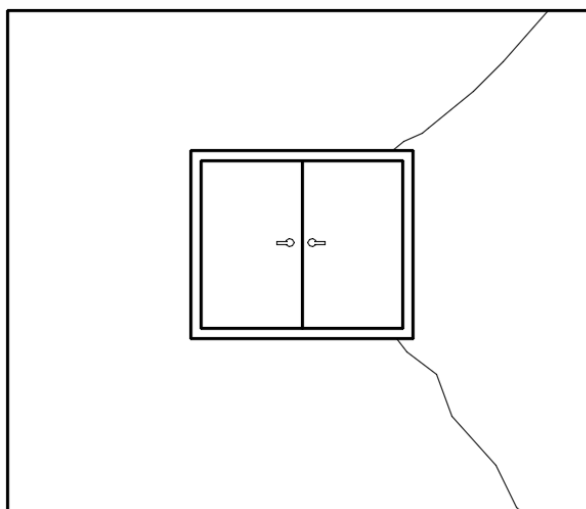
Fissura surgindo ao lado do vão de janela sem verga e contraverga, com inclinação próxima de 45° . Fonte: autor.
